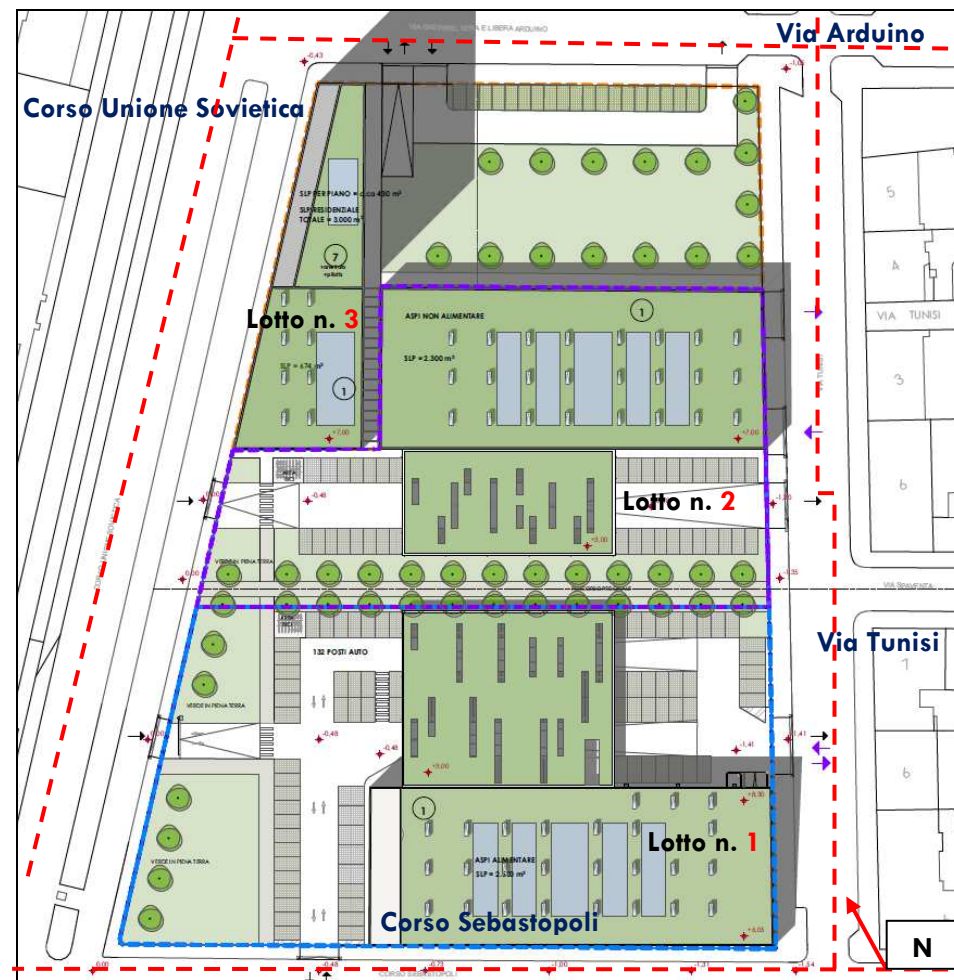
Estratto progetto architettonico: planimetria P.E.C.
